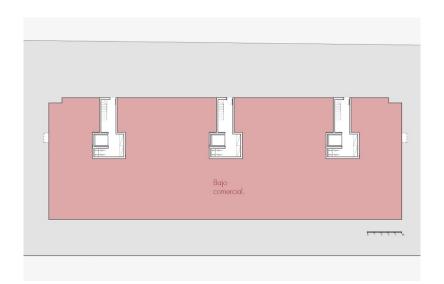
Plano de planta baja y comercios 1. Fuente: elaboración propia.
